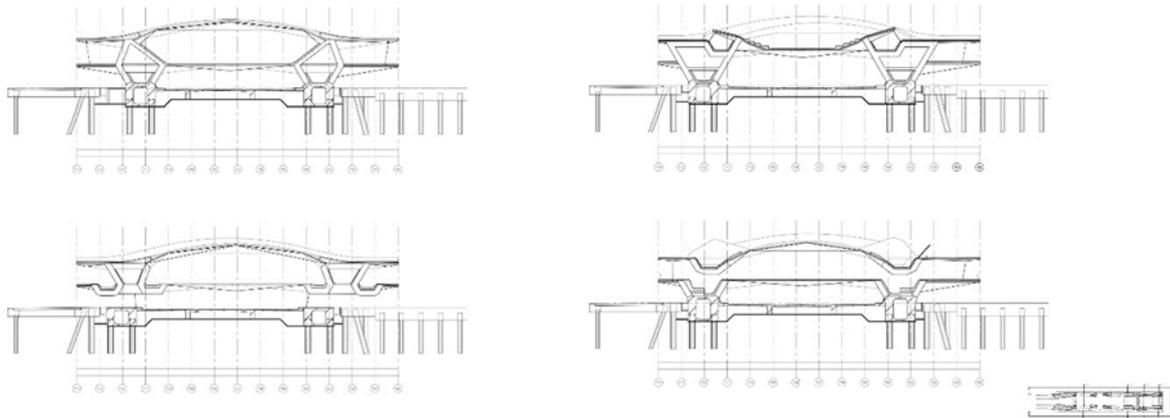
FOA, Secuencia de secciones para la construcción de la Terminal Internacional Portuaria de Yokohama, 1994
